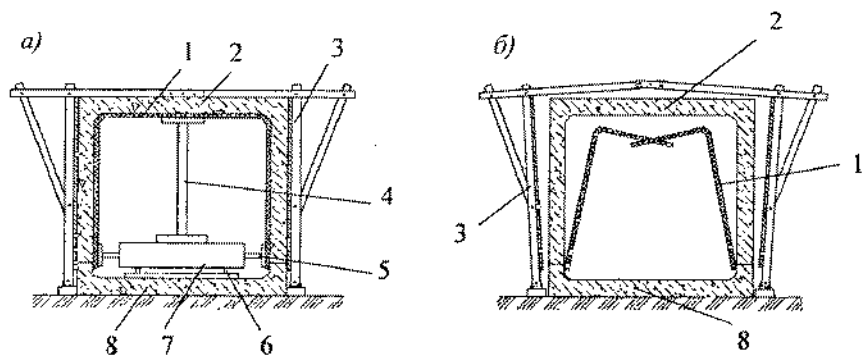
Катучая опалубка для бетонирования подземных коллекторов:
